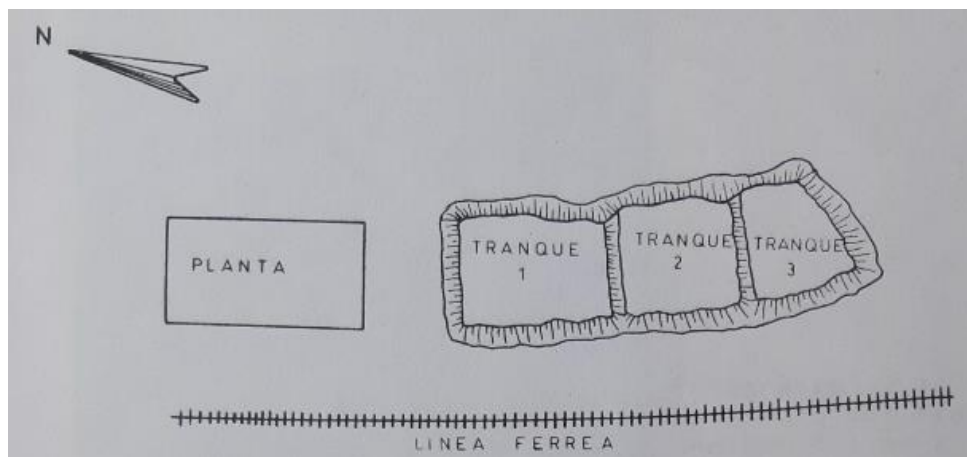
Esquema adjunto de la planta Los Molles, Levantamiento Catastral 1989-1990.
